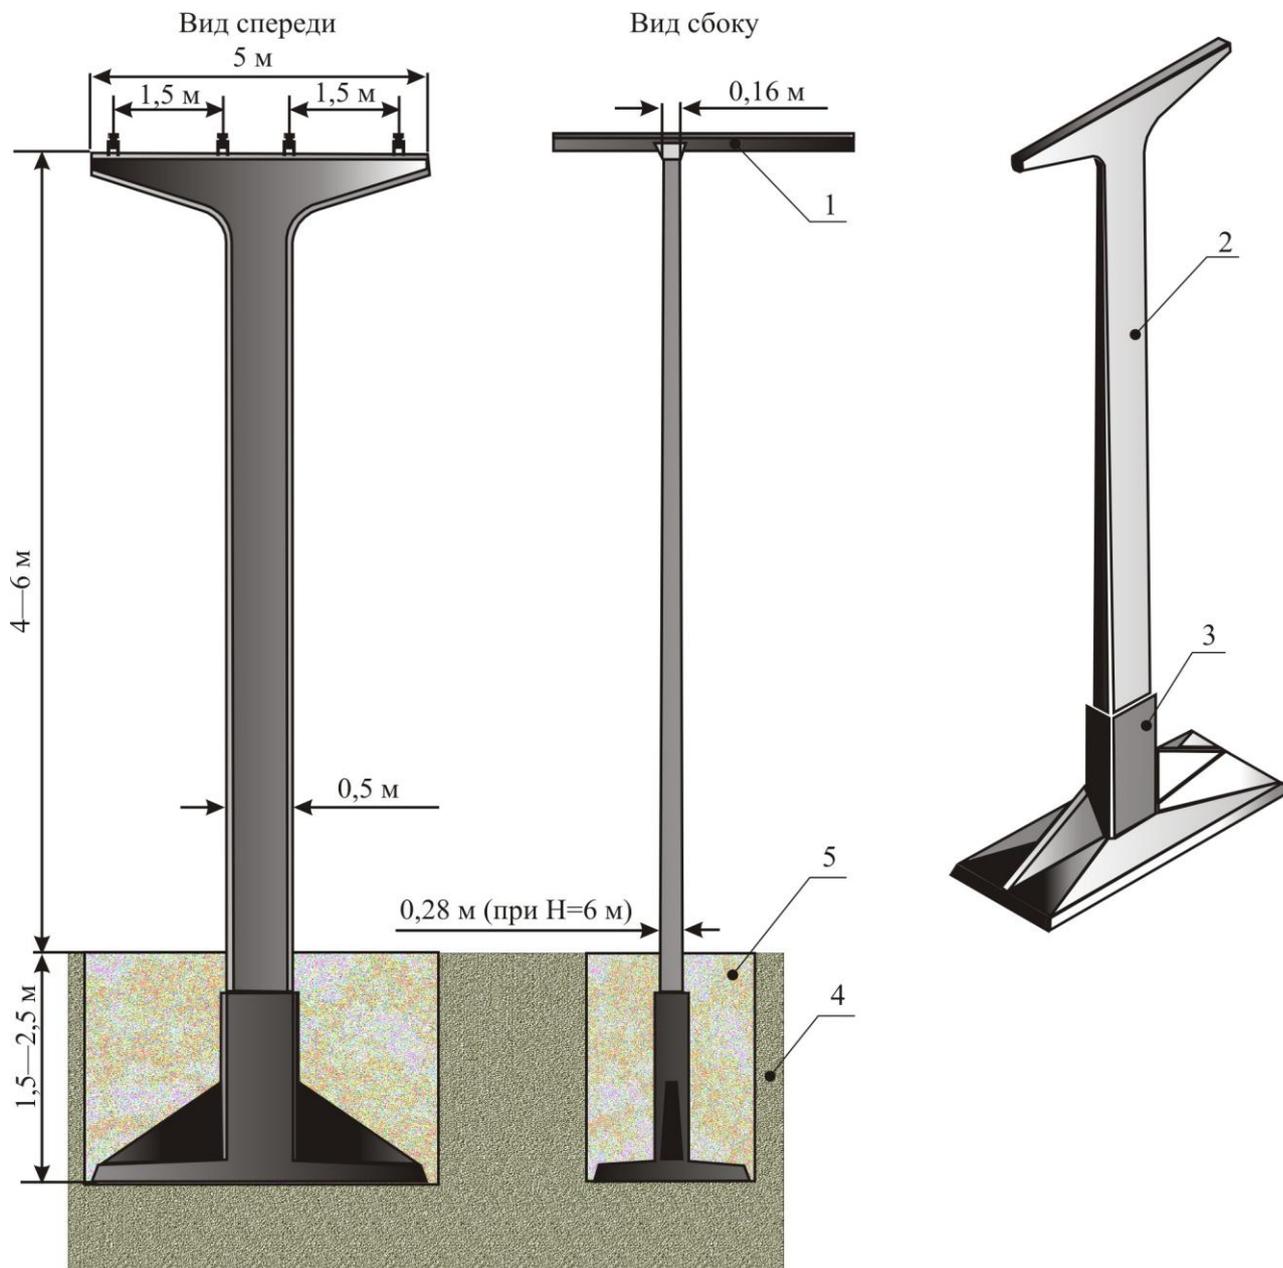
Промежуточная железобетонная поддерживающая опора двухпутного бирельсового СТЮ колеи 1,5 м: 1 — рельс-струна; 2 — опора; 3 — фундамент; 4 — земля; 5 — выемка грунта
